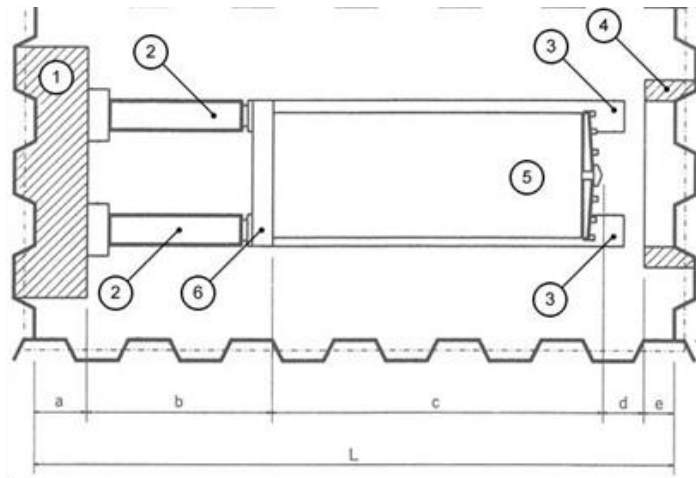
Startbaugrubenabmessungen bei rechteckförmiger Grundrissform und Verbau aus Spundbohlen bei vorgegebener Vortriebs-/Schildmaschine und Pressstation [46]
